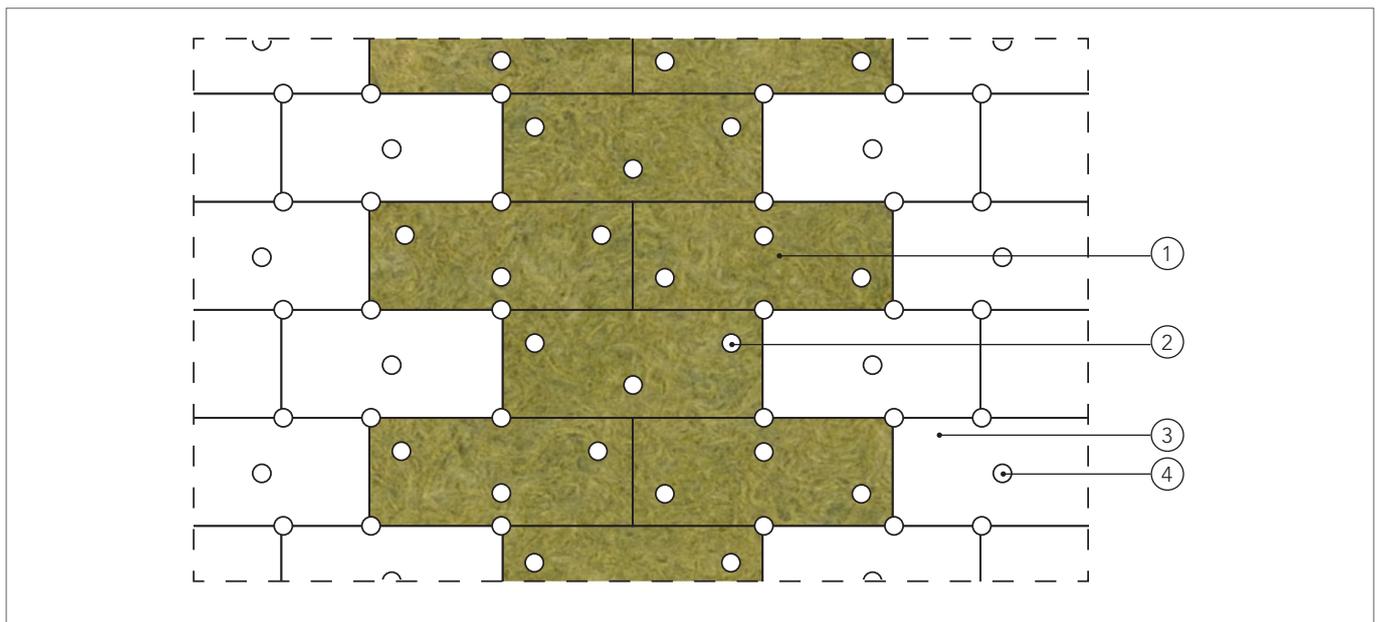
Fascia di separazione verticale in lana di roccia in un sistema a cappotto in EPS; schema di posizionamento pannelli isolanti e tasselli
